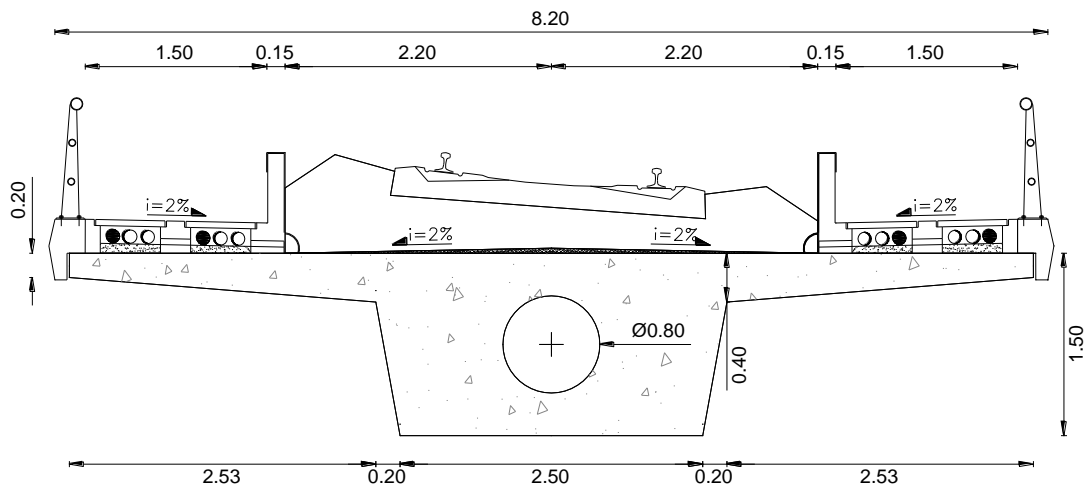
SECÇÃO TRANSVERSAL 2 DO VIADUTO FERROVIÁRIO (SECÇÃO ALIGEIRADA)
